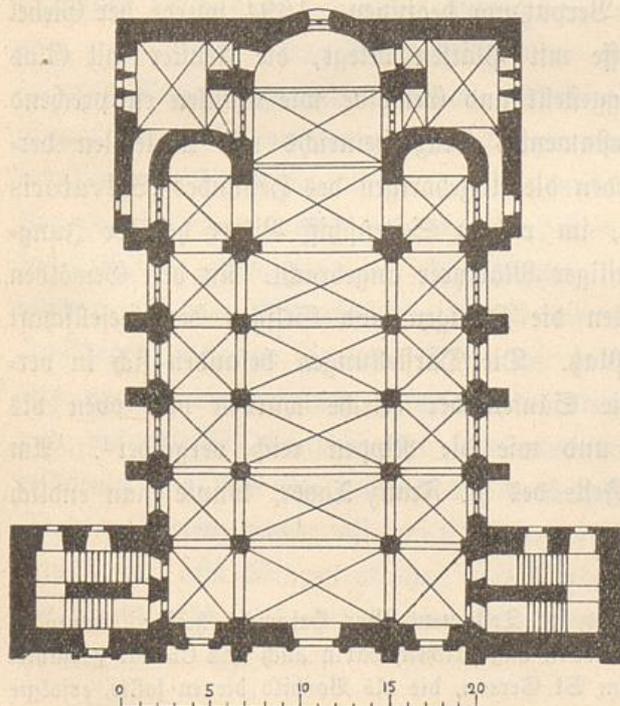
Bonn. Namen-Jesuitenkirche. Grundriß.
